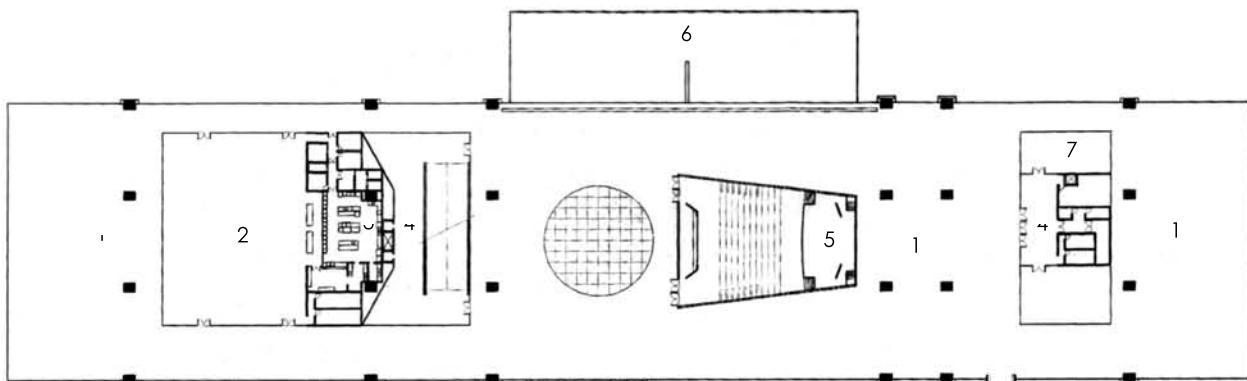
PLANTA BAIXA MUSEU OSCAR NIEMEYER
